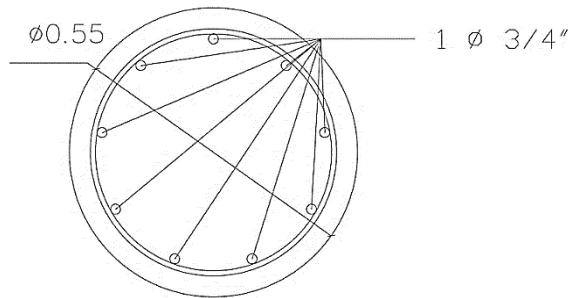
Sección y Distribución de los Aceros de la Columna Circular.
